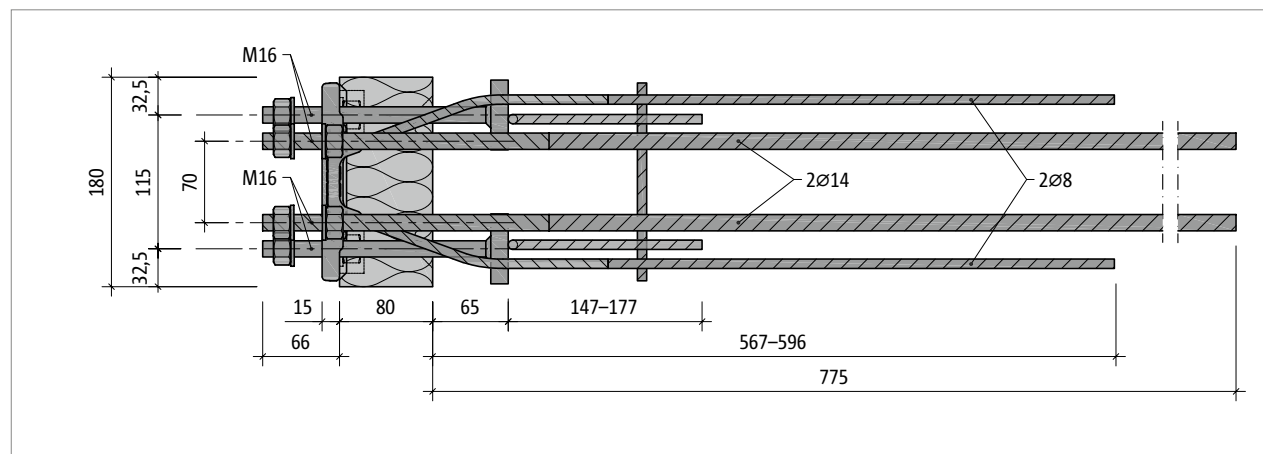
Schöck Isokorb® T type SK-M1-V1 : vue en plan
